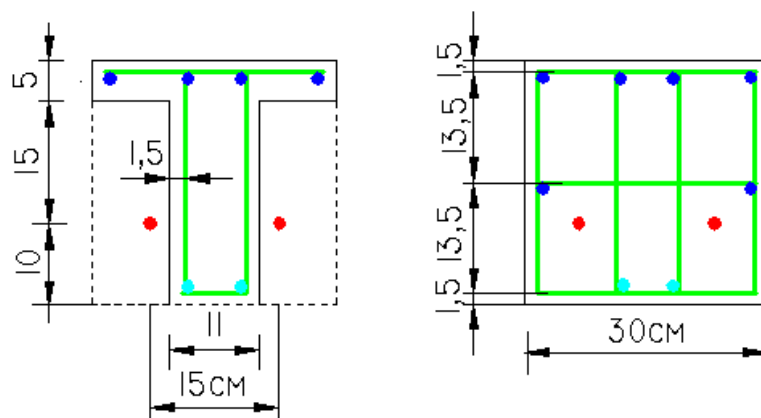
Cortes AA' e BB' das seções da viga.
